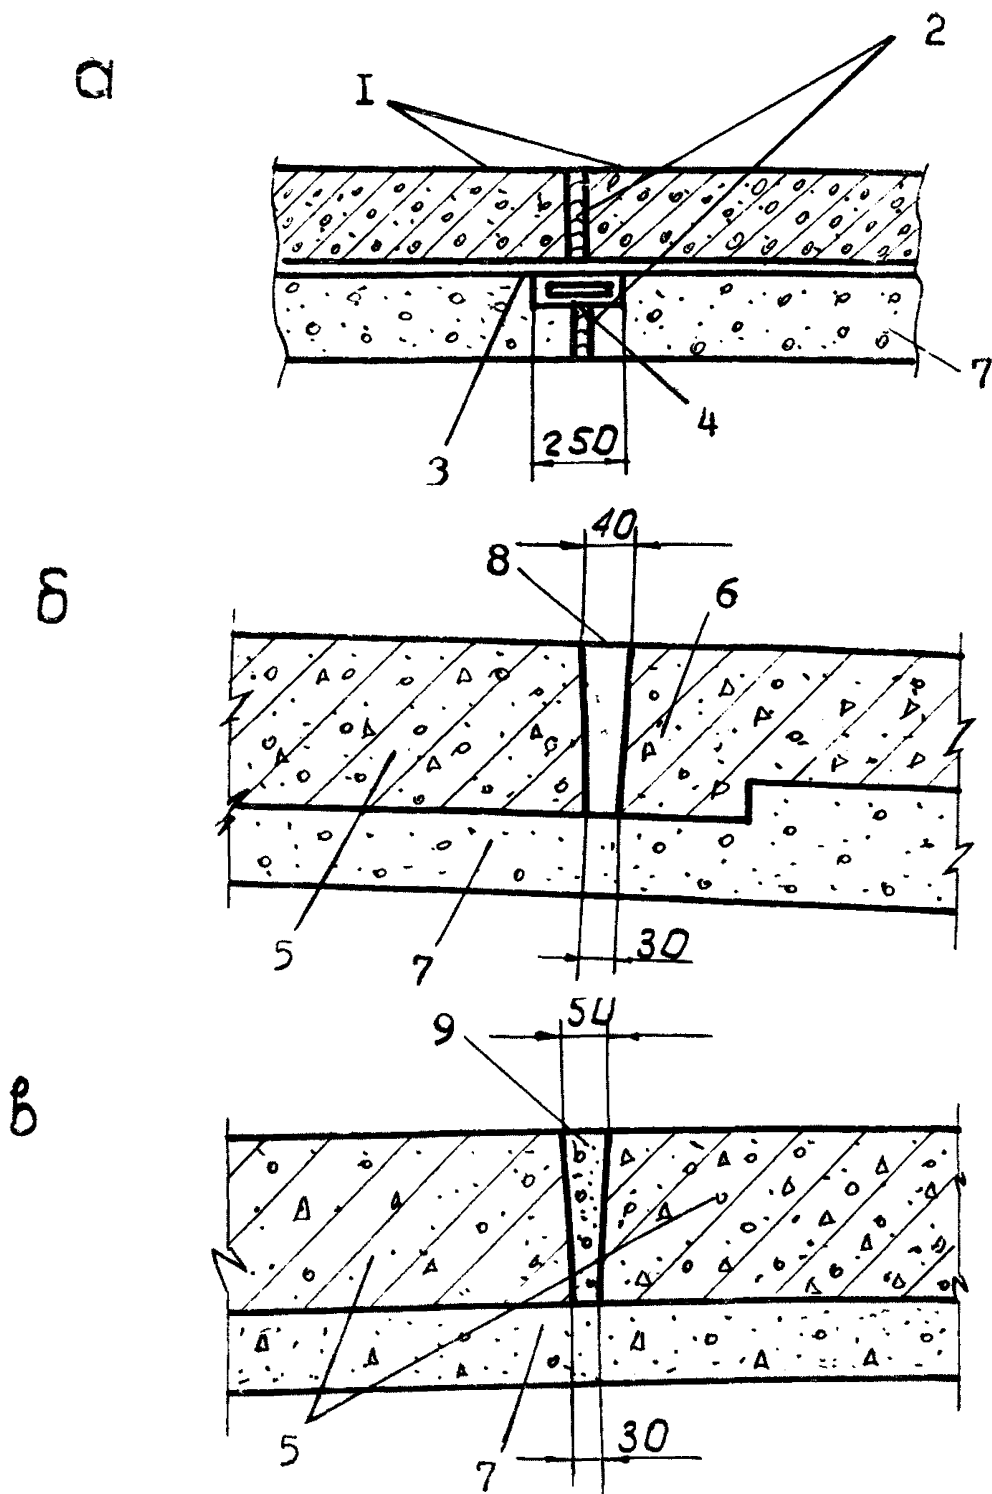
Герметизация швов дна вентиляционных каналов:
